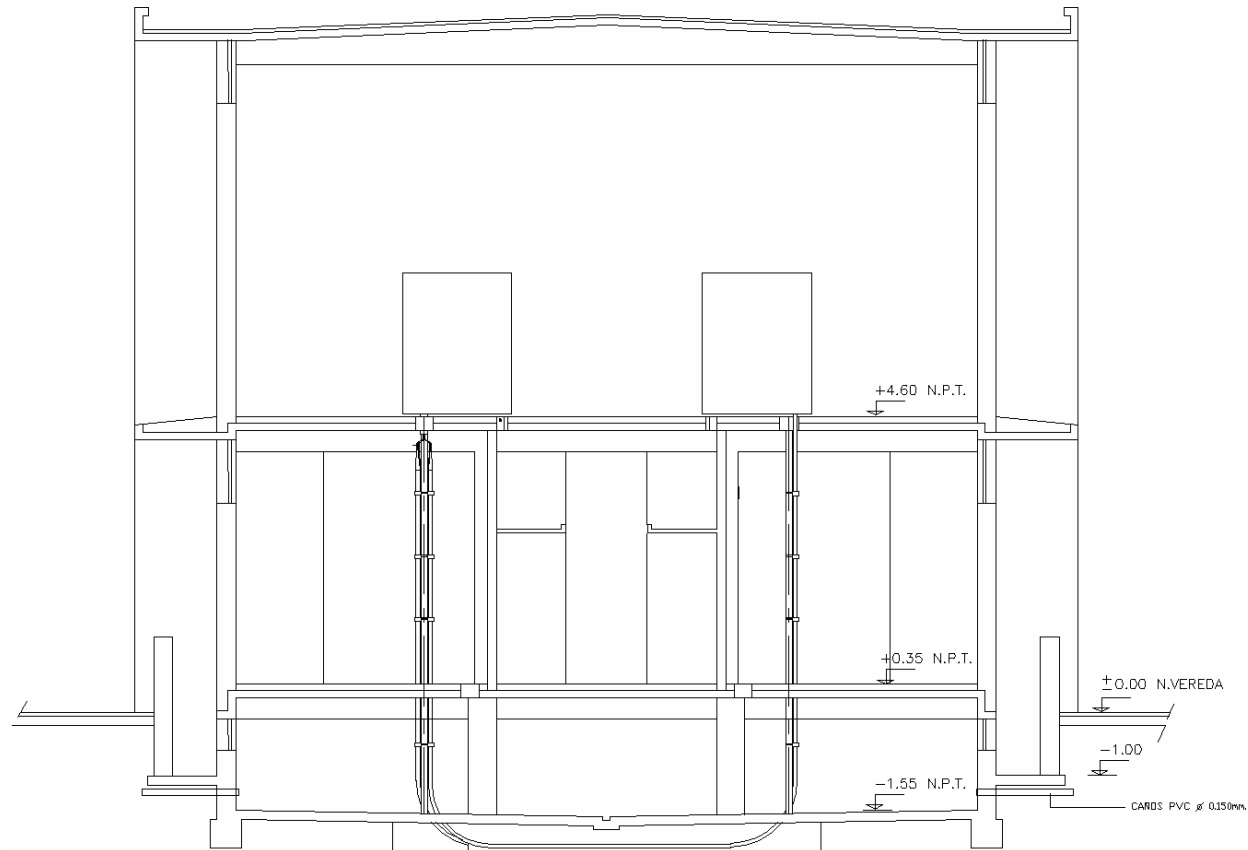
Equipos de media tensión. Planta y cortes.
